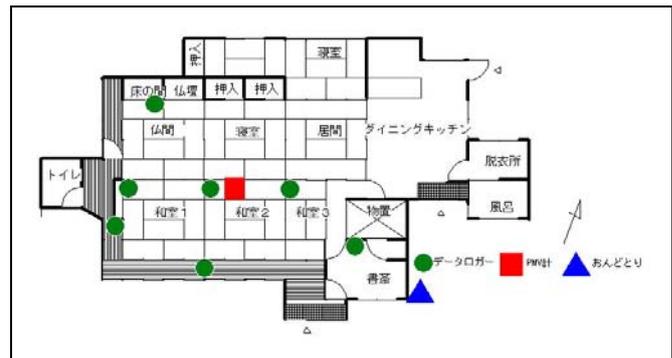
K邸平面図（上） 図 4 E邸平面図（下）
